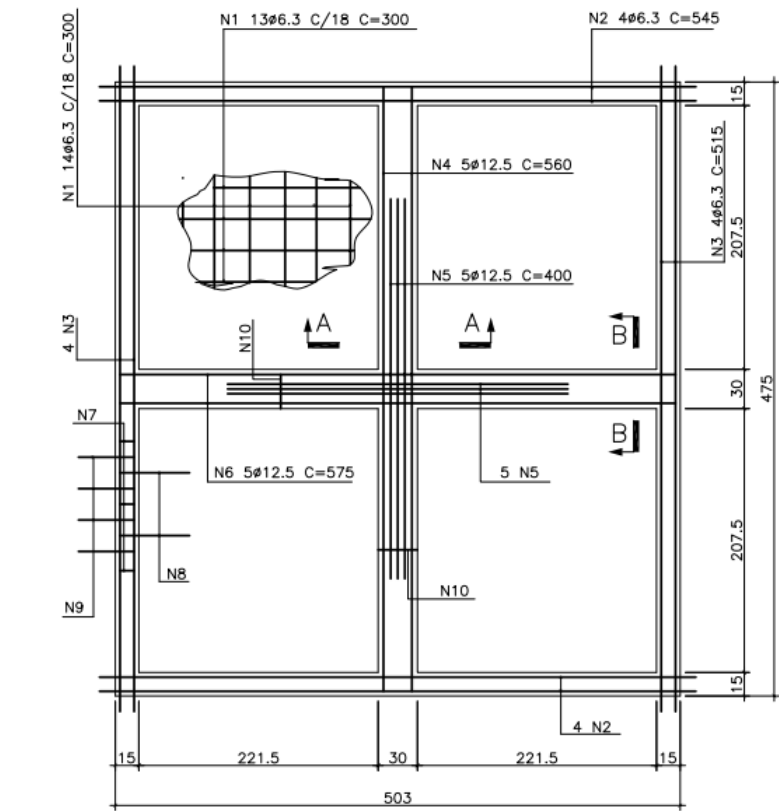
Armaduras especificadas no projeto para cada módulo
